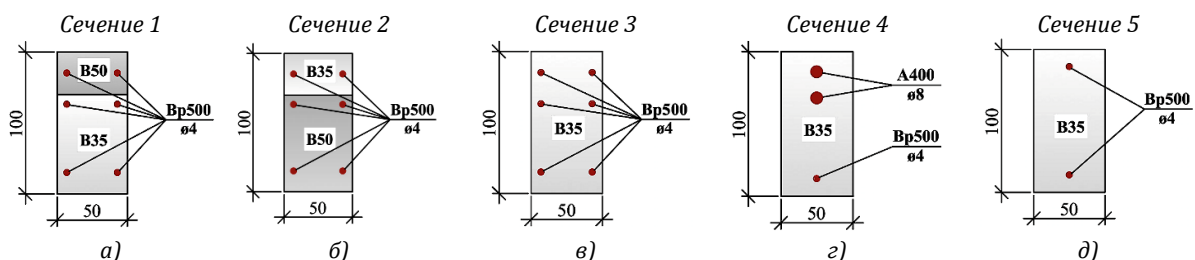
Варианты конструктивного исполнения рассматриваемых сечений железобетонных ригелей:
